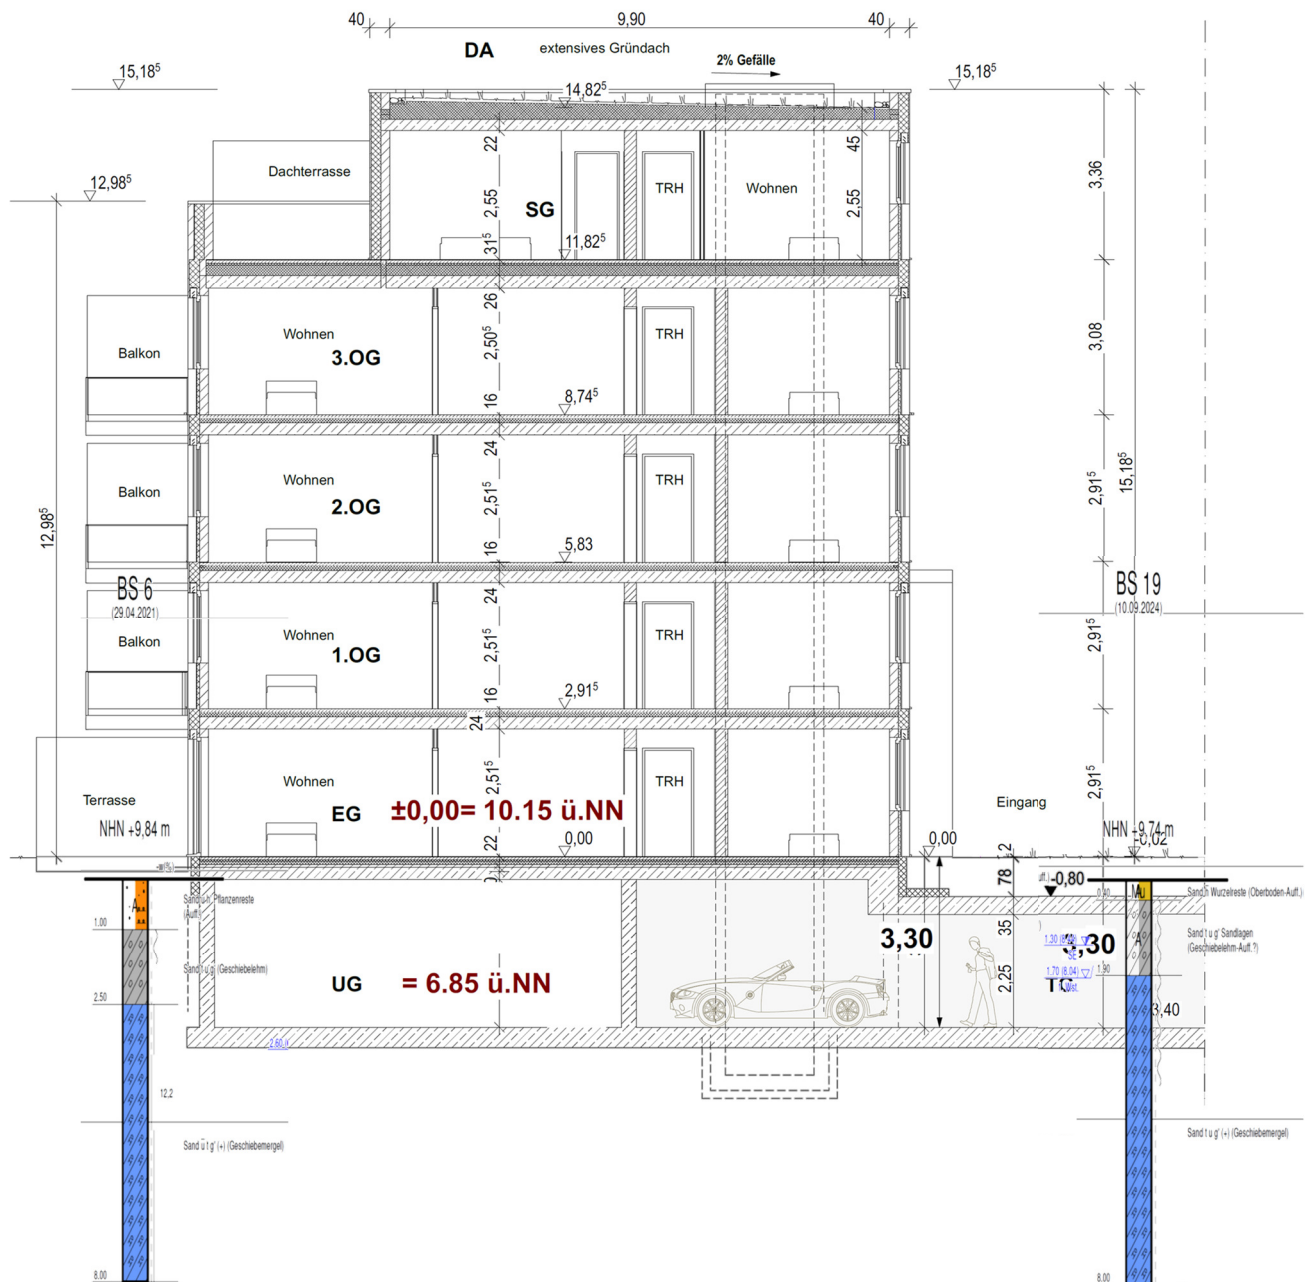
Schnitt Haus Typ B / Teilschnitt Tiefgarage im 2. BA, M 1:150
